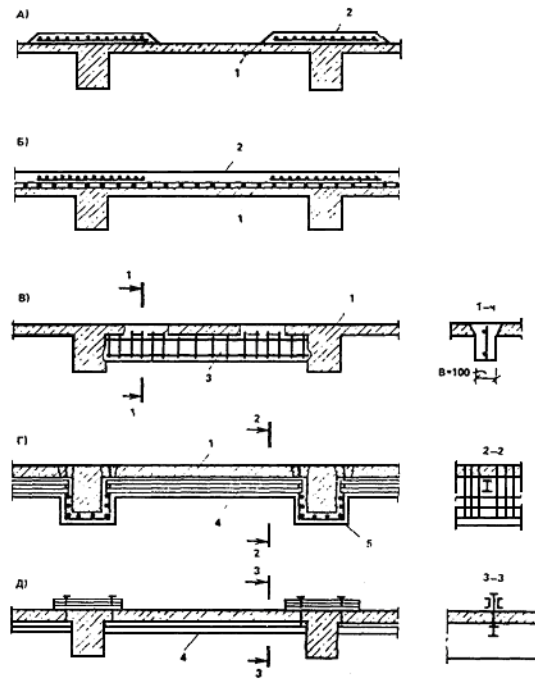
Усиление плит железобетонных монолитных перекрытий
